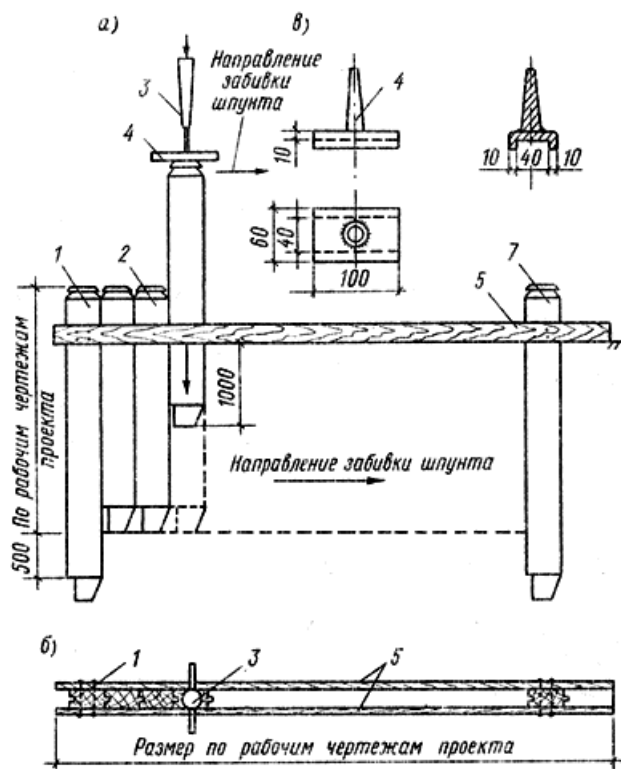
Схема забивки шпунта(стрелками показано направление забивки)
